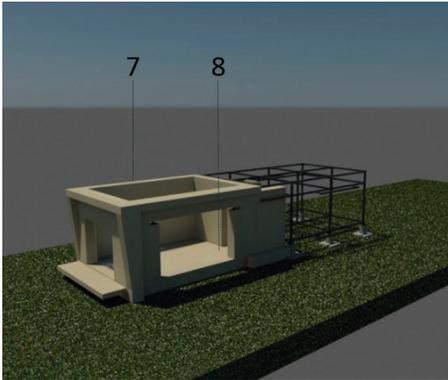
Proceso 7: construcción de formaleta y baseado de concreto reforzado para viga de corona muro de tapia. Proceso 8: baseado de mortero de suelo y nivelación de piso acabado.
